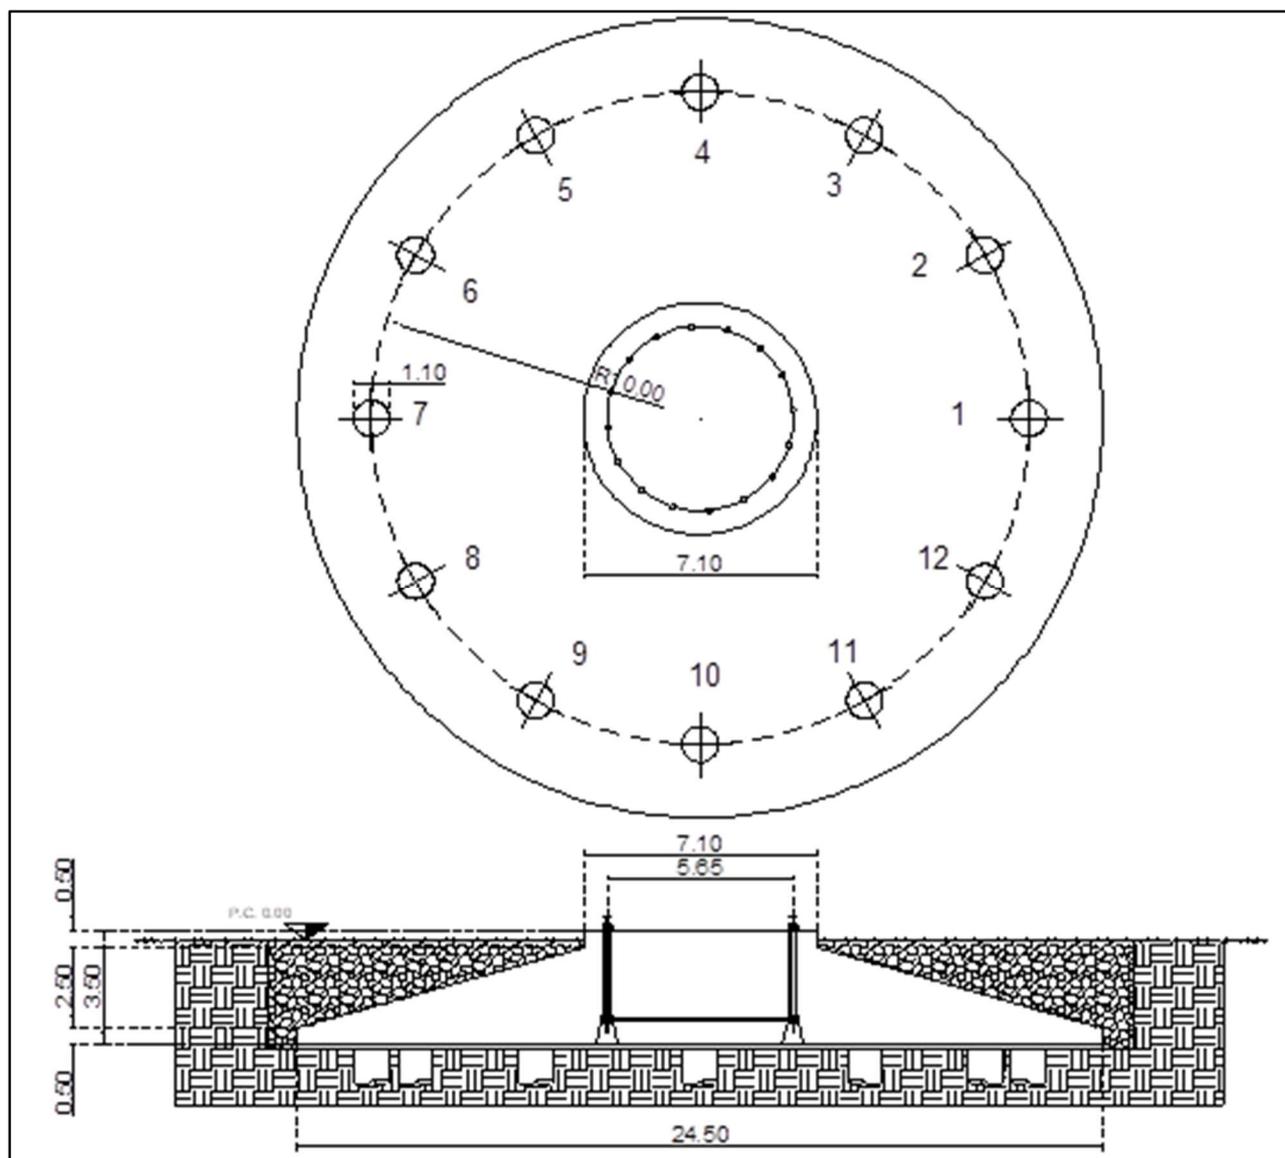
Dettaglio pianta e sezione fondazione
